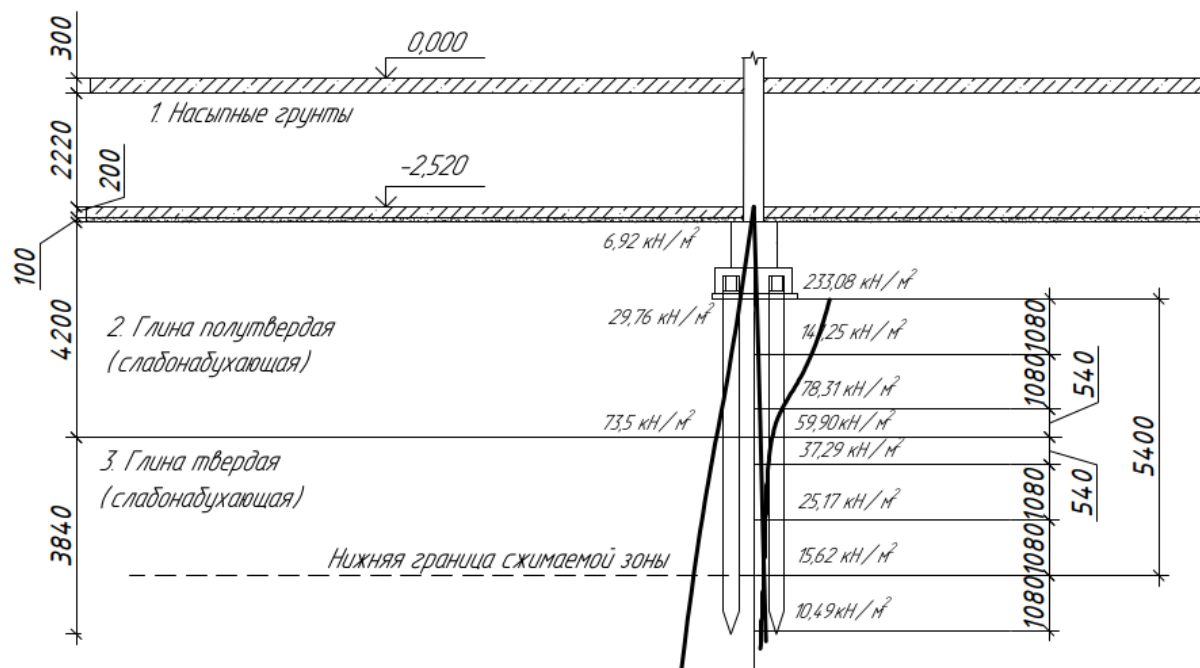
Расчетная схема осадки свайного фундамента
